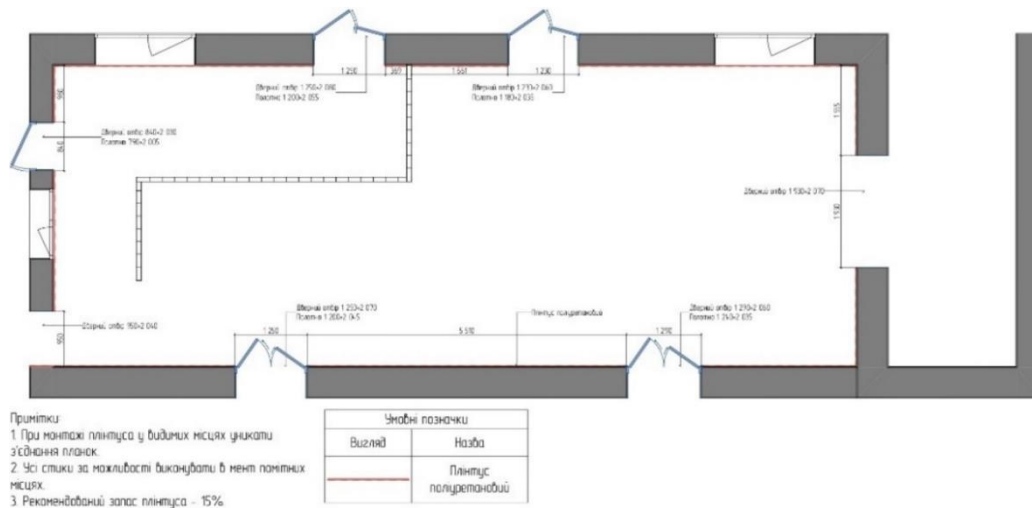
Схема плану відкривання дверей і плінтусу
